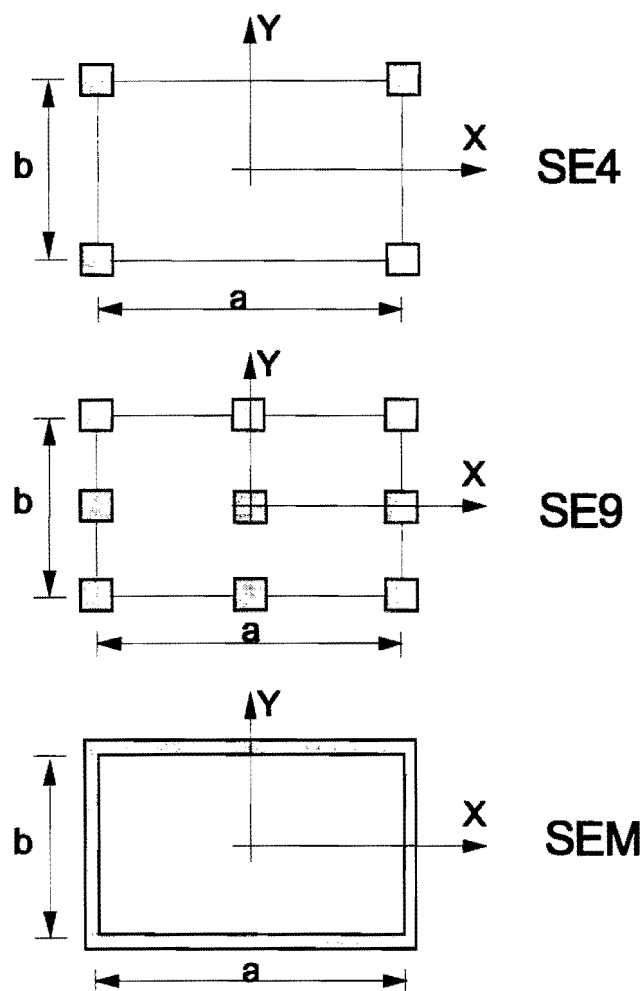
Sistemas estructurales de estudio: losa rígida sobre cuatro columnas (SE4), nueve columnas (SE9) y sobre cuatro muros perimetrales (SEM).
